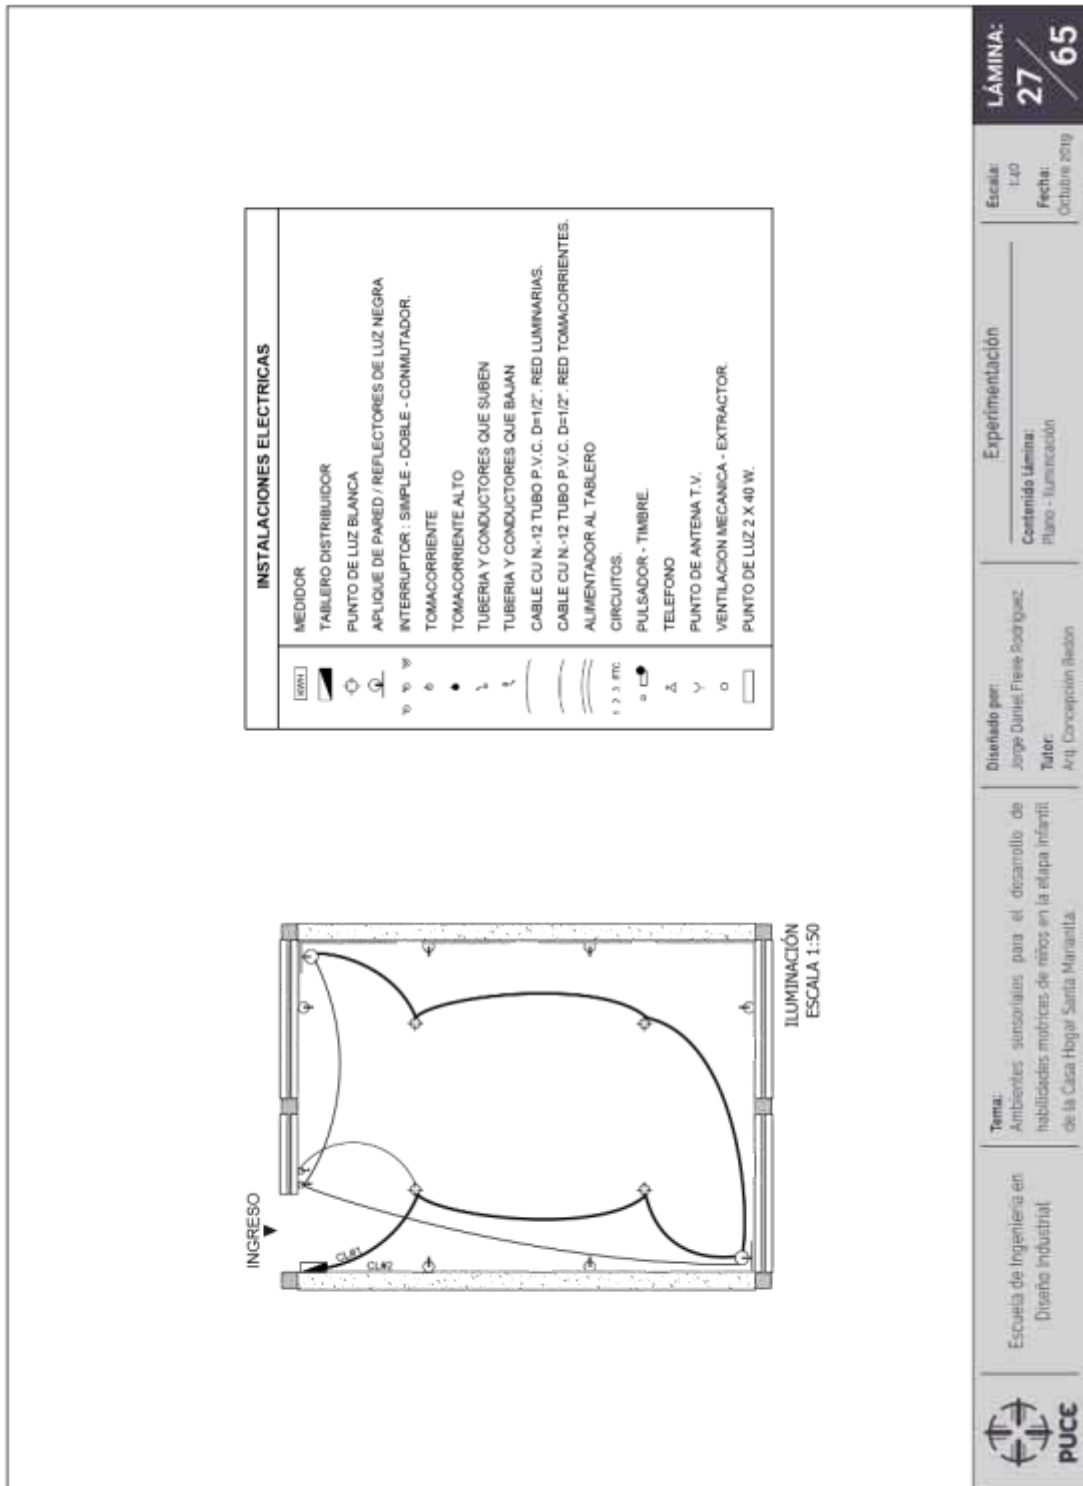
Sala oscura - Planta de fondo permanente - Techo
